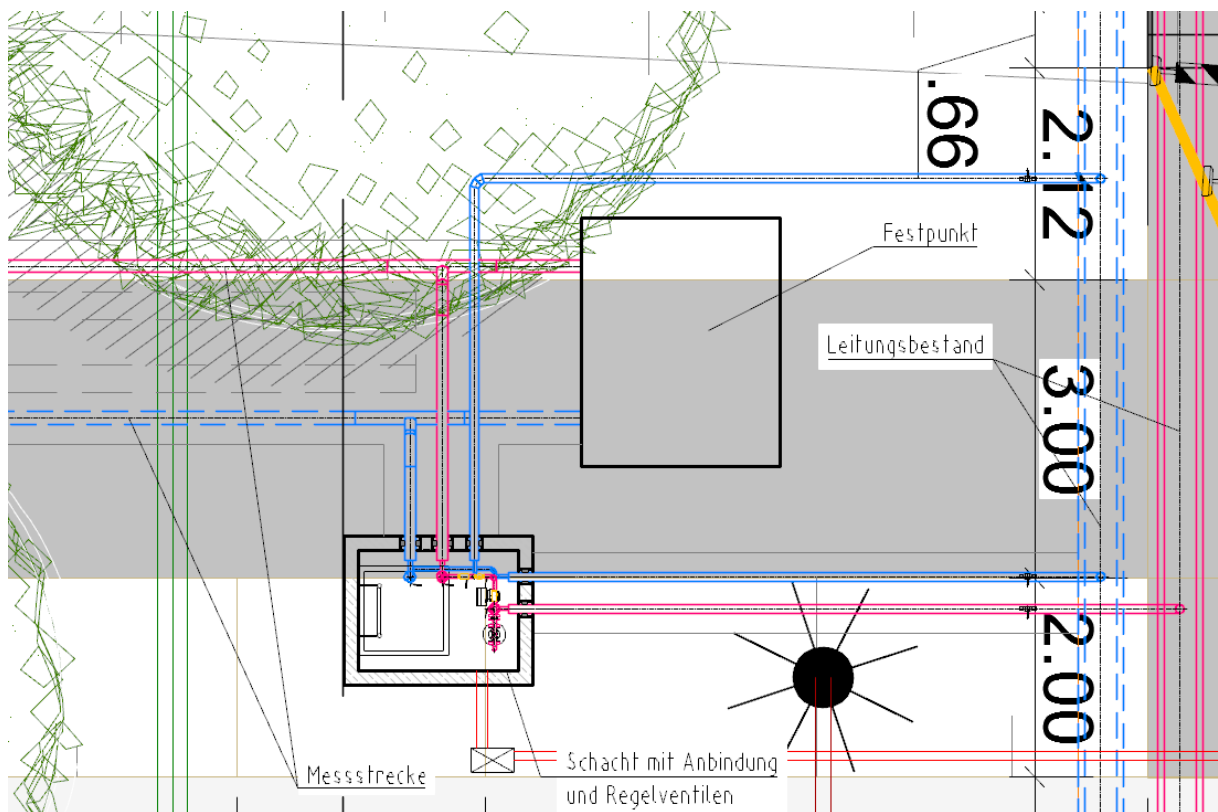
Versuchsstrecke am Festpunkt und Anbindeschacht mit Regelventilen
